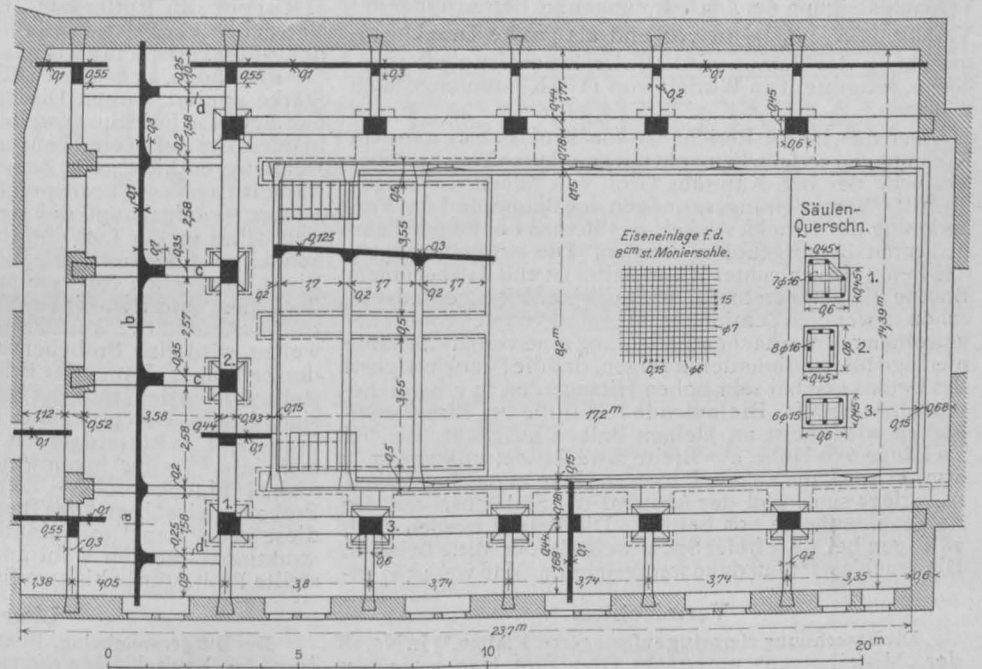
Grundriß der Schwimmhalle mit Angabe der Eisenbeton-Konstruktionen.
